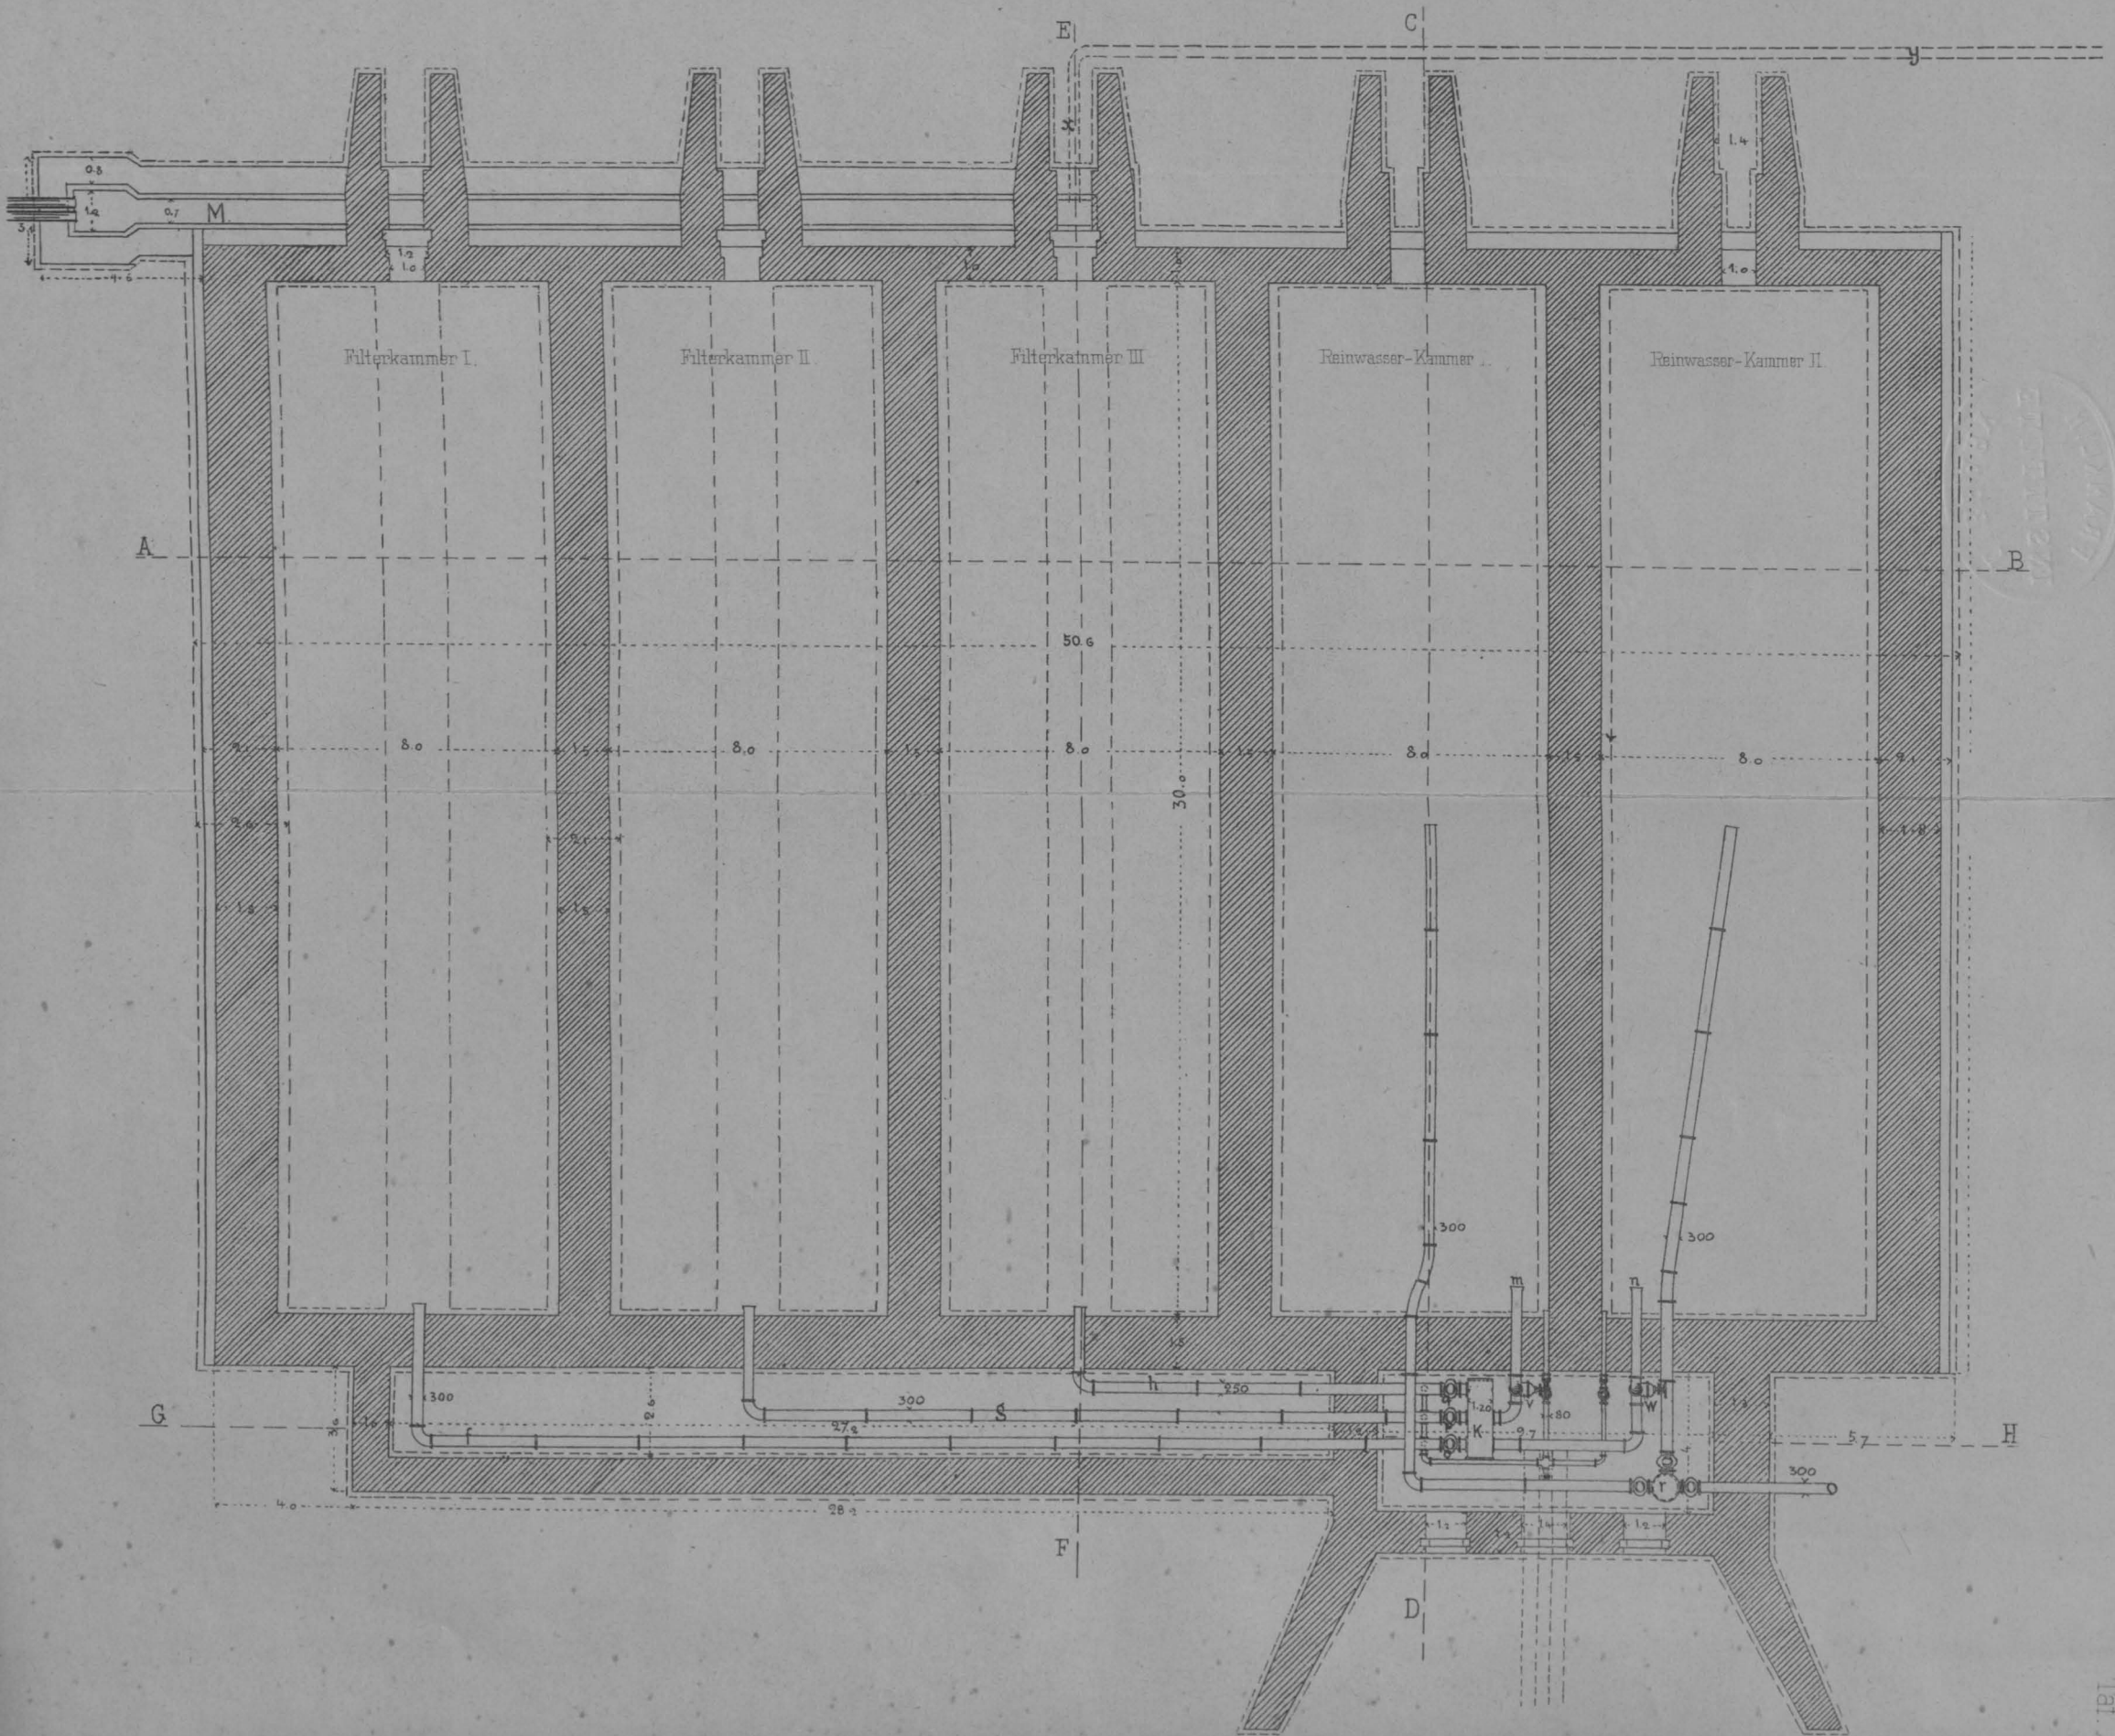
Grundriss der Filter- und Reinwasser-Kammern und der Schieberkammer
